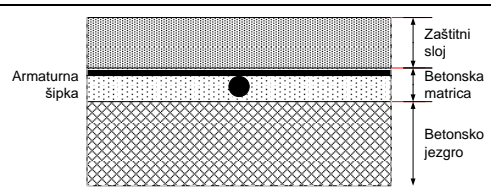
Unutrašnje raslojavanje betona (Inner delamination of concrete) u stubu
